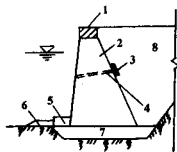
现浇混凝土和浆砌块石结构断面示意图
